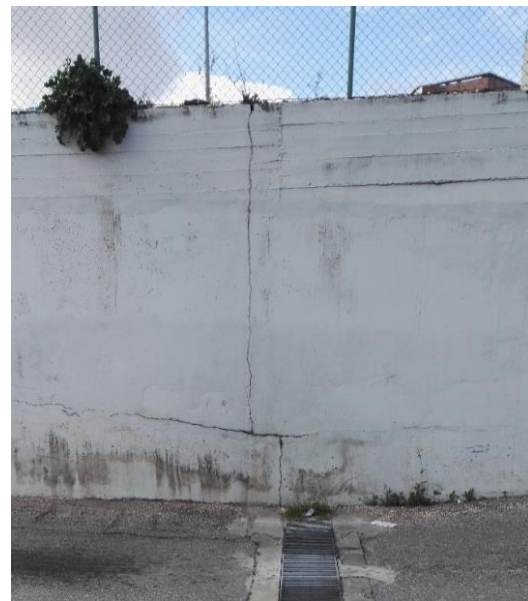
Fissuração generalizada no muro de suporte (Fonte: Autor).
